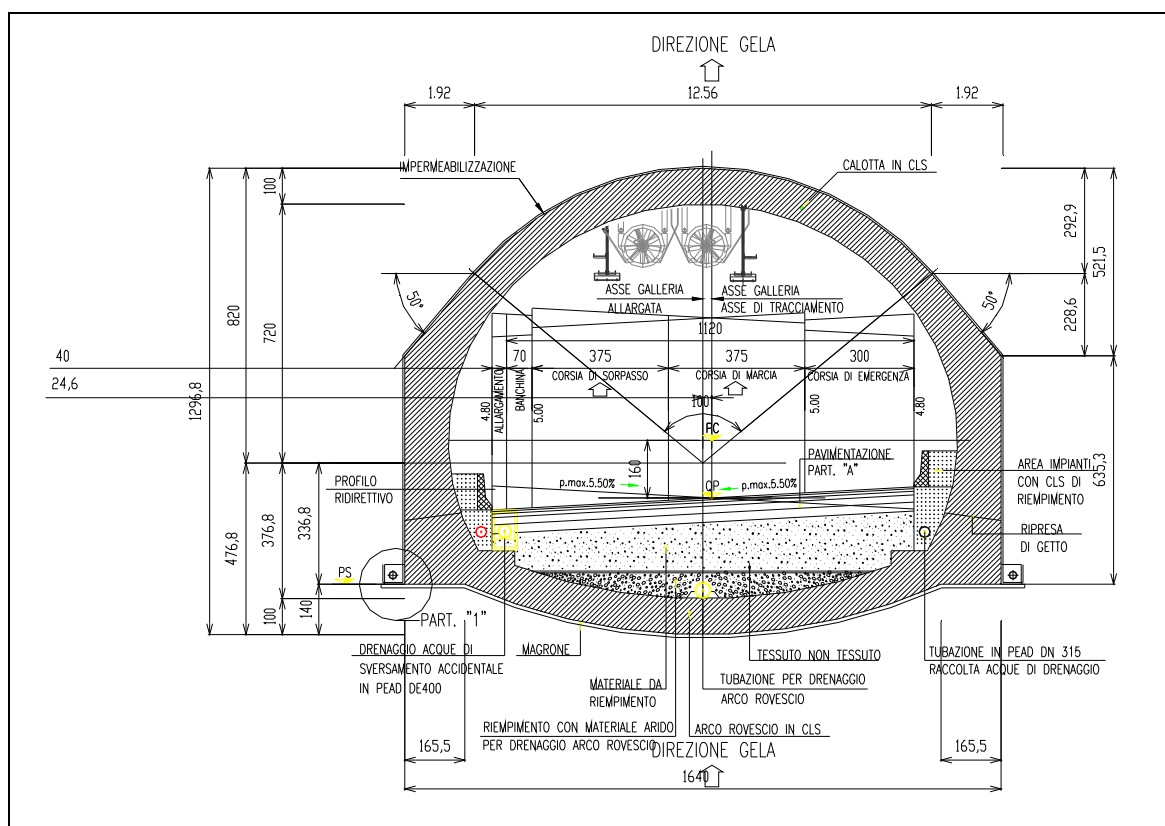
Op.22 "Galleria Truncafila" sezione tipo artificiale
